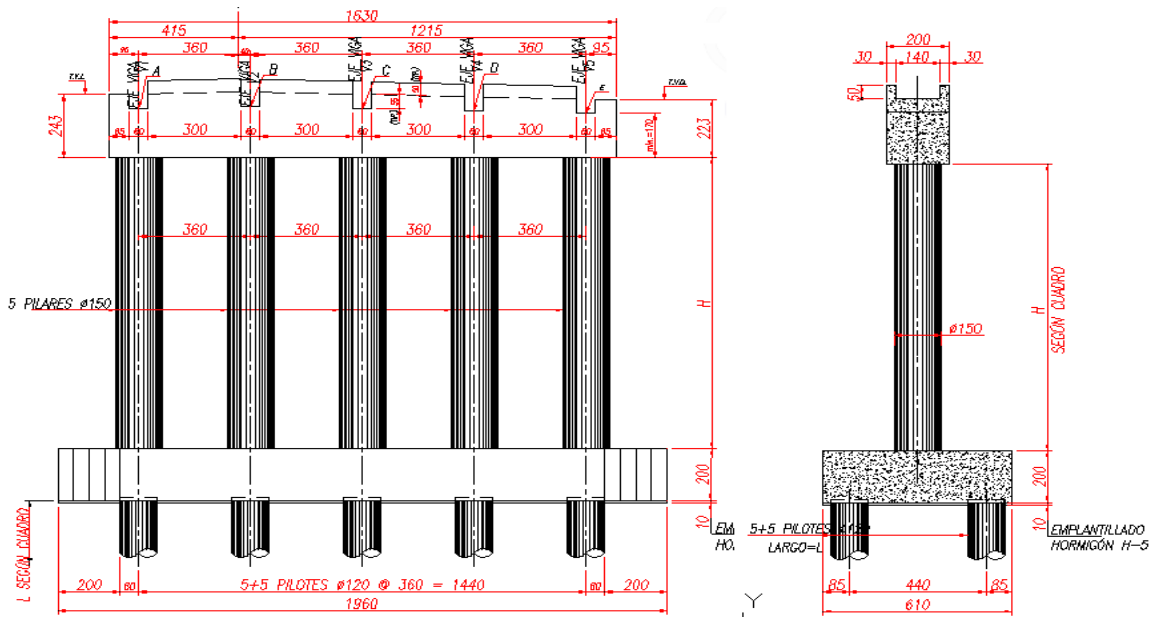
dimensiones en centímetros de elevación cepa tipo A.
